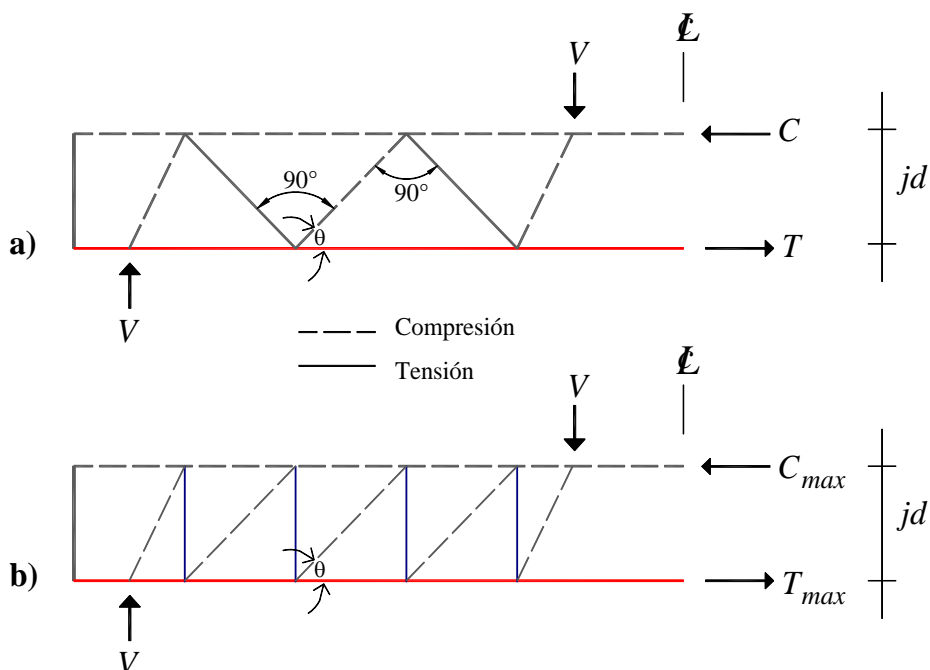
Modelos de armadura para una región B según Schlaich *et al.* (1987): a) armadura con tensores de concreto (agrietamiento) y, b) armadura plástica de ángulo variable (falla)
